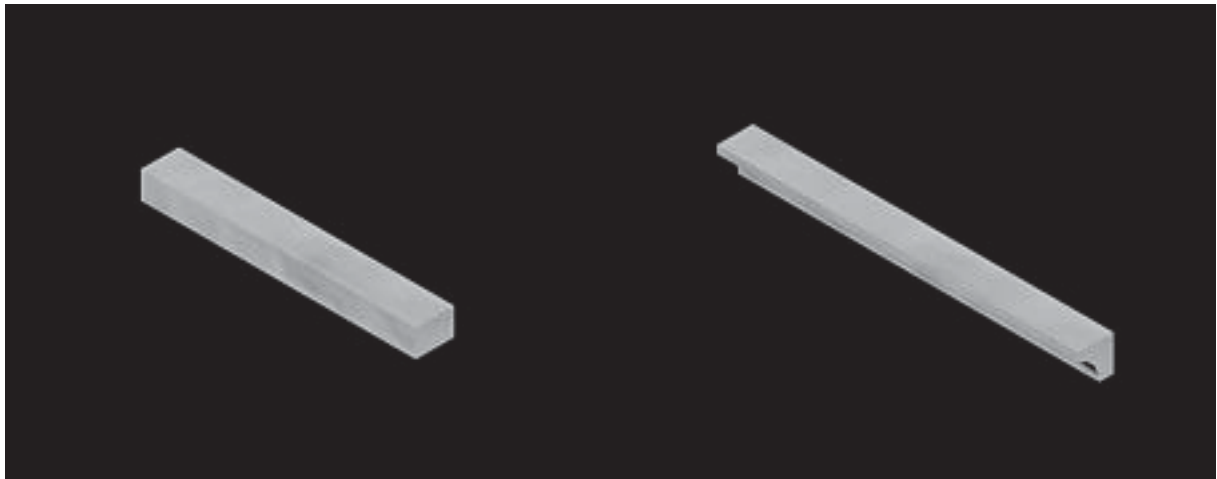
Muro/banco com a forma de um paralelepípedo em betão, semelhante ao da marginal mas apenas em betão (sem revestimento de granito)
